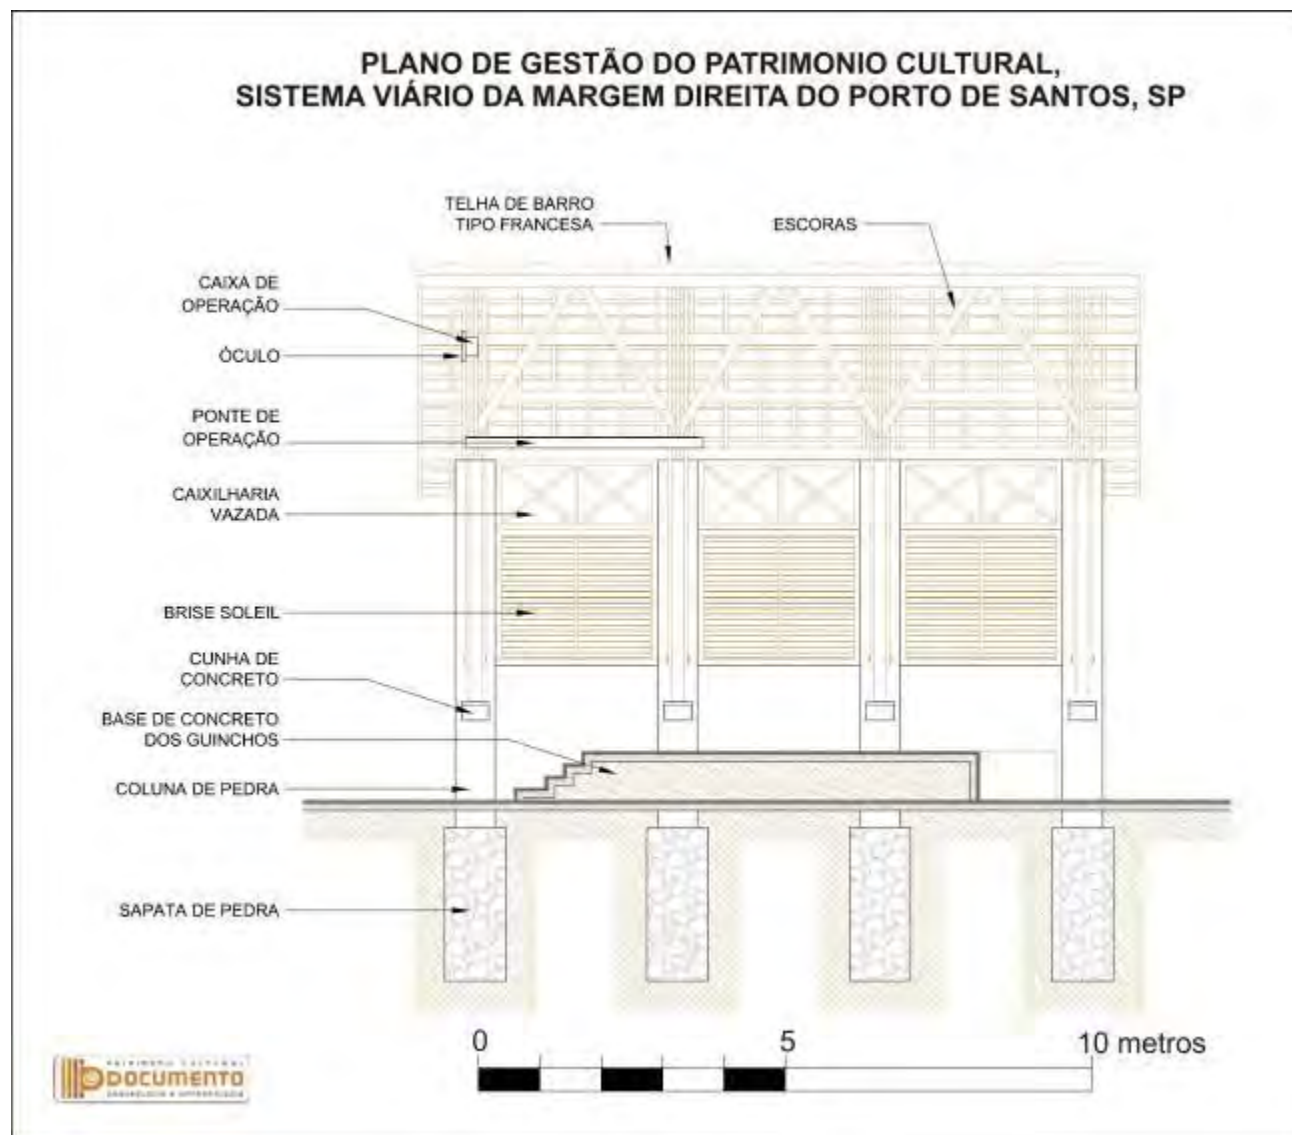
Corte esquemático da base dos guinchos, Fonte: Planta de Situação, 1986.
